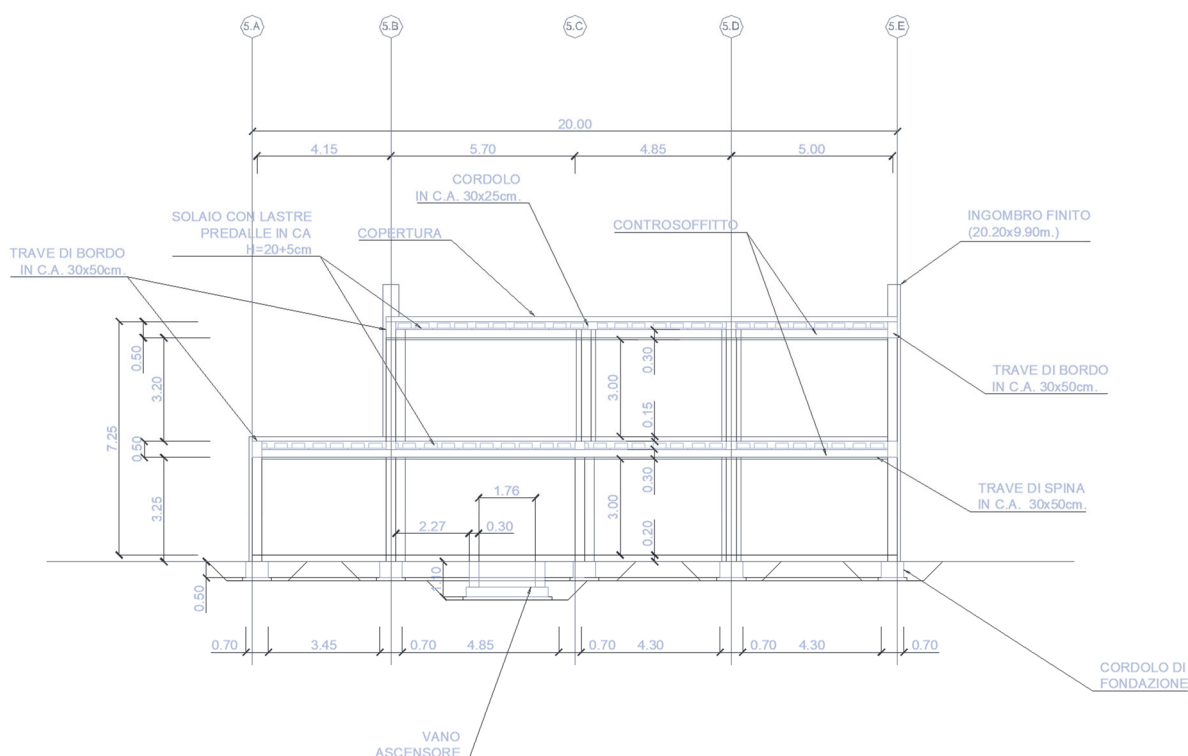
SEZIONE DELLA PALAZZINA UFFICI
